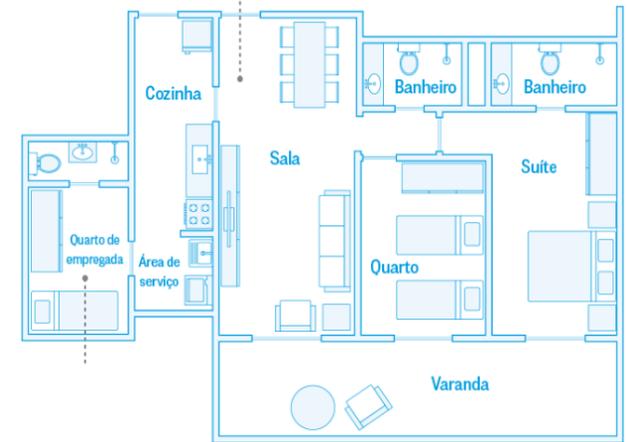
Planta baixa moradia anos 80. (Fonte: Blog da arquitetura)
